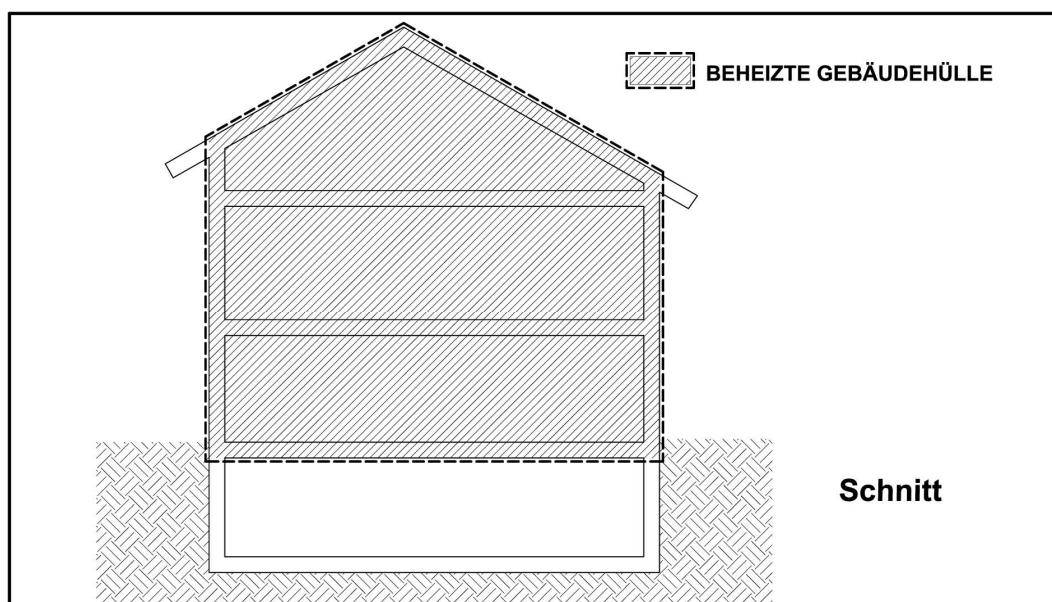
Gebäude mit beheiztem Dachgeschoss und unbeheiztem Kellergeschoß
